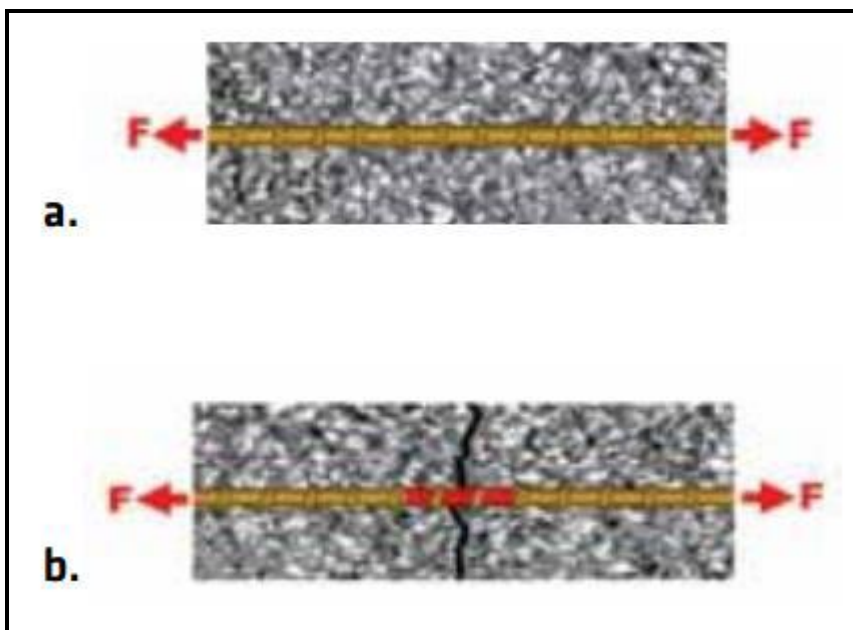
a. Fuerza de Tensión Aplicada a un Elemento de Concreto Reforzado.
